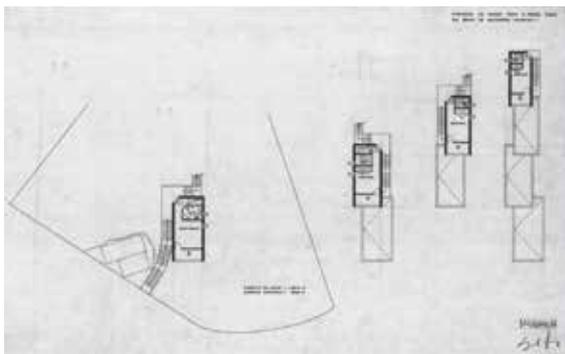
Miguel Fisac. Vivienda en Mazarrón. 1968. Plantas (Fuente: Internet).
